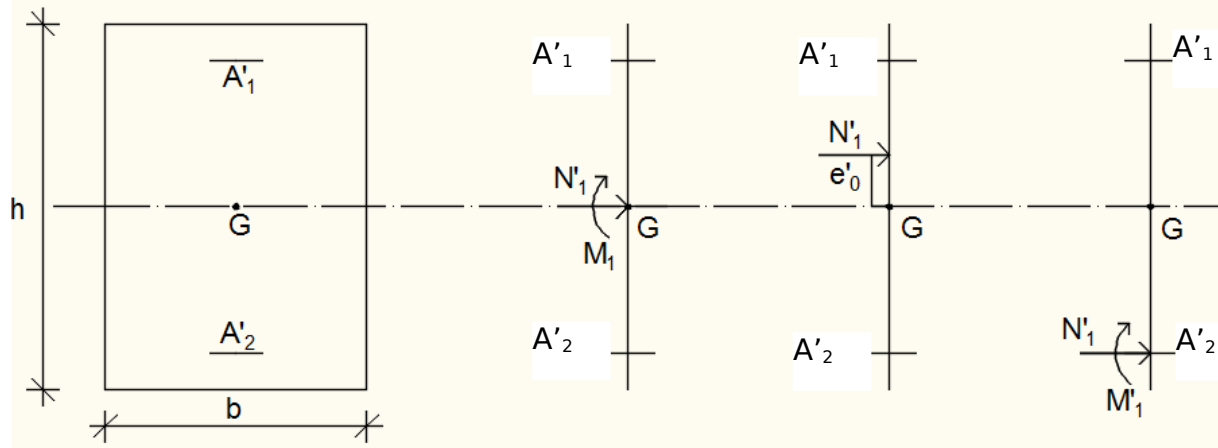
Position de N'_1 , M'_1 et M_1 sur la section transversale.
